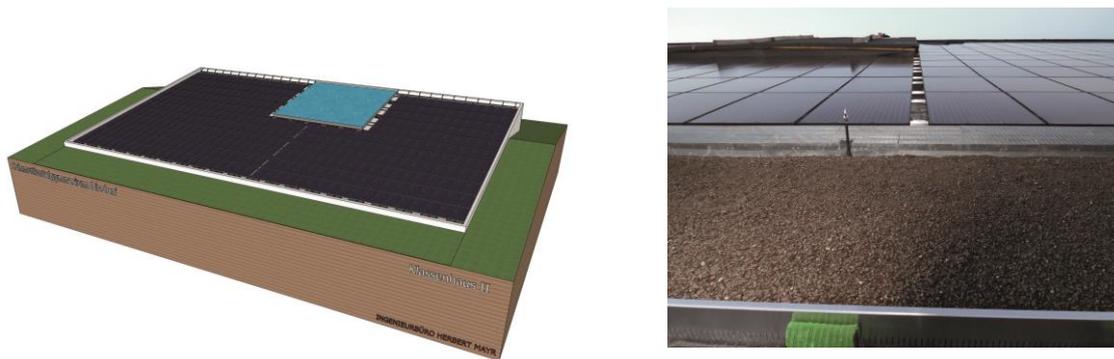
Die PV-Anlage: links in Planung, rechts bereits im Bau
